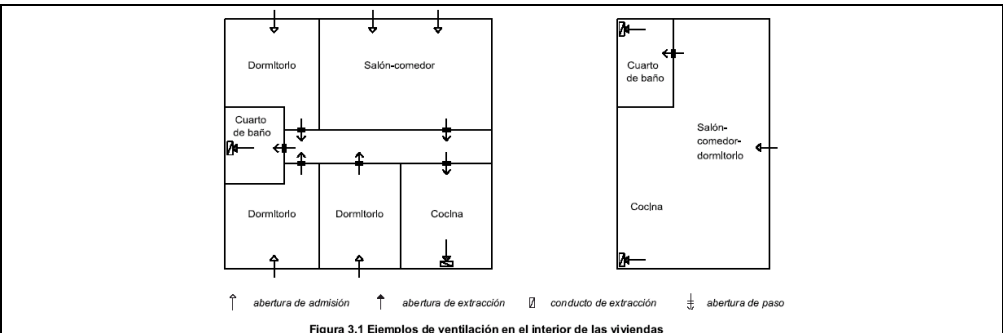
Ejemplos de ventilación en el interior de las viviendas
